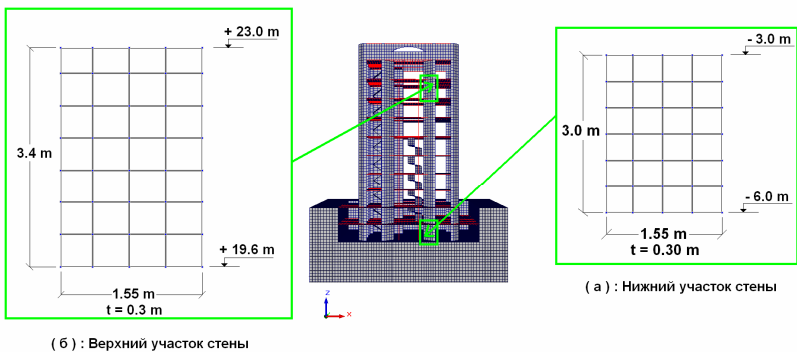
Расположение и размеры участков монолитных железобетонных стен здания – вариант (С)
